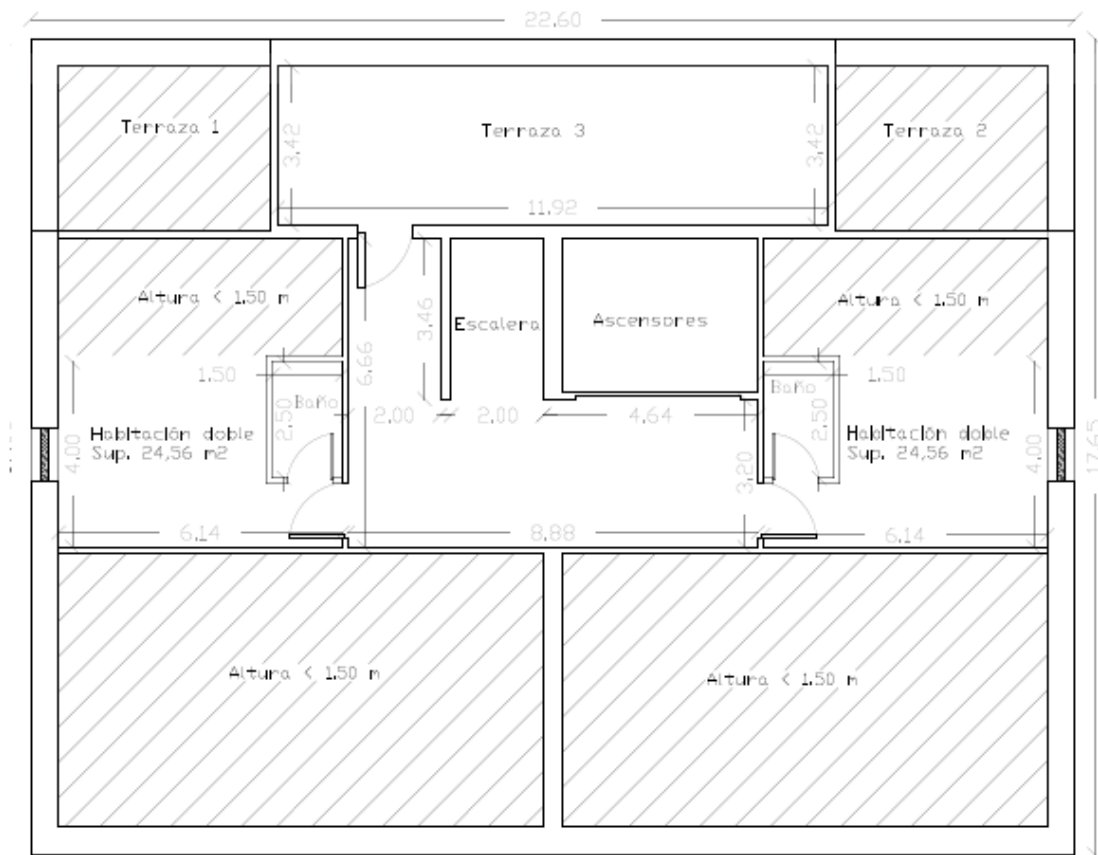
Extracto de la planta bajo cubierta redistribuida. Fuente: Elaboración propia
